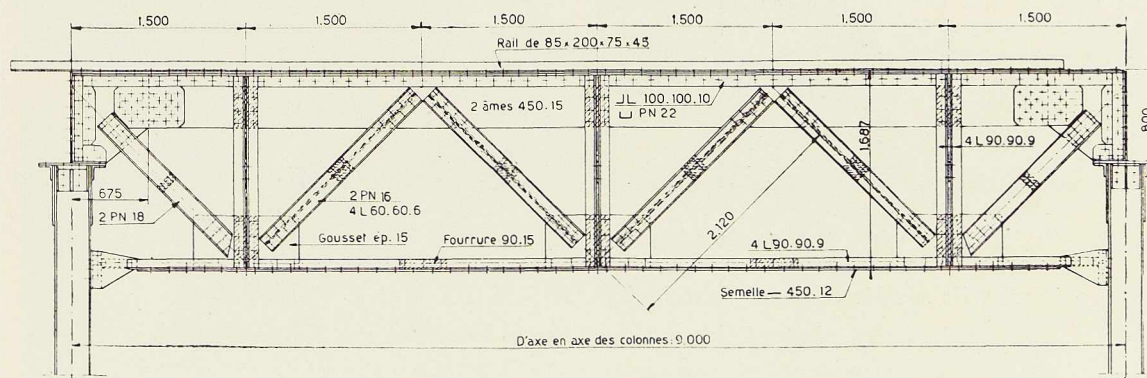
Détail d'une poutre de roulement du hall de 22 mètres.
